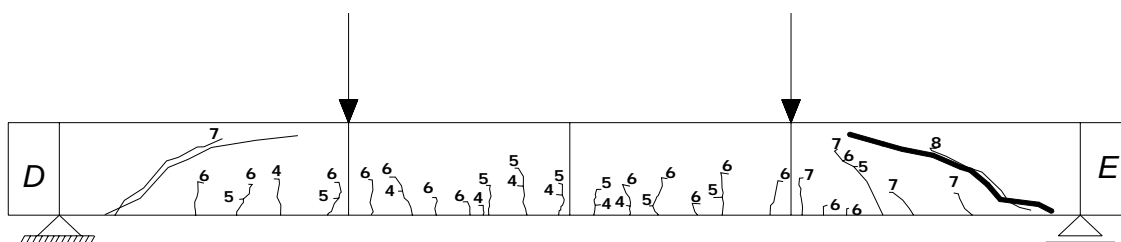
Padrão de fissuração para a viga V50-2 com armadura transversal
